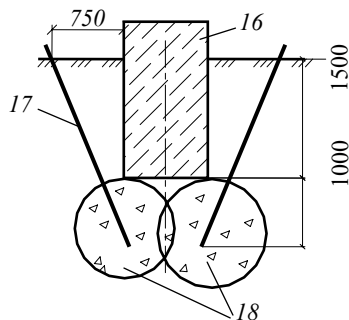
Схематический разрез инъекционного закрепления грунтов в основании фундаментов:
